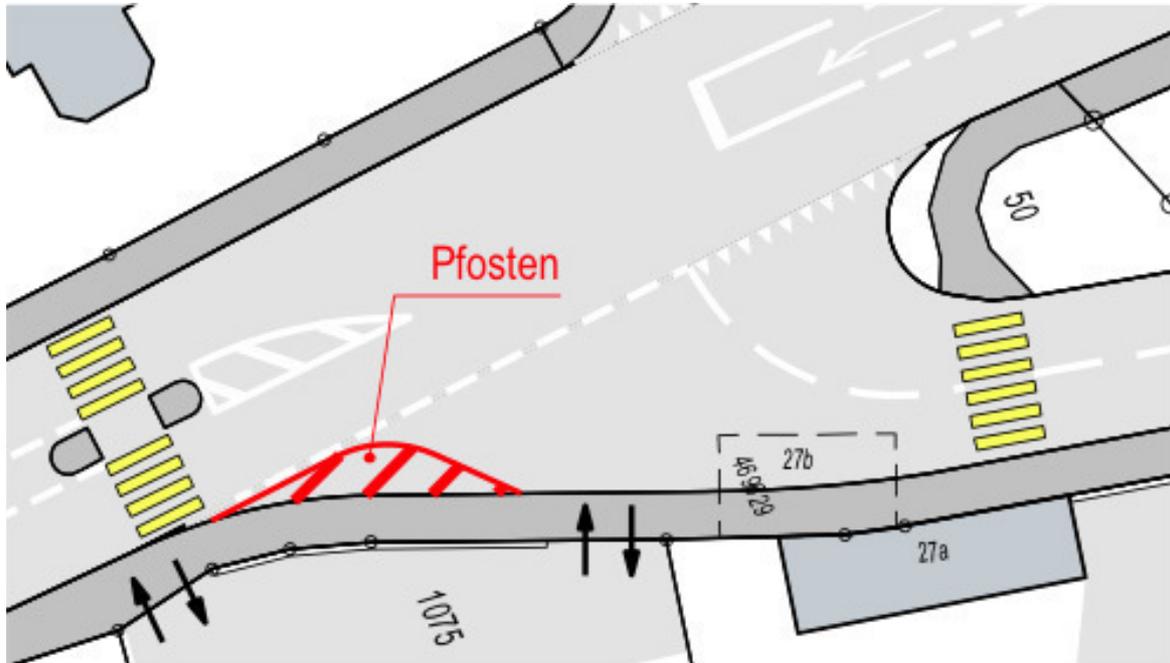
Planausschnitt Massnahme Anpassung Einfahrt Hohlestrasse
